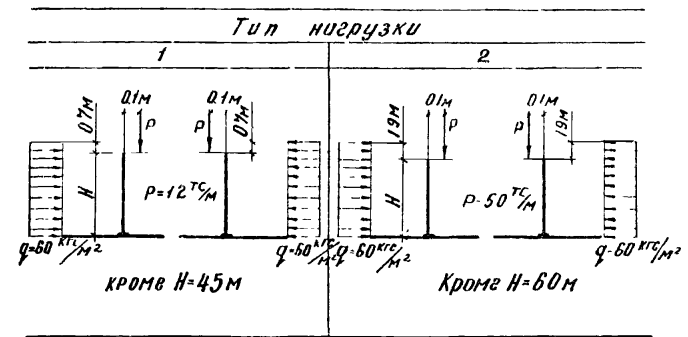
Схемы расчетных нагрузок на перегородки высотой 3,6 + 6,0 м.
